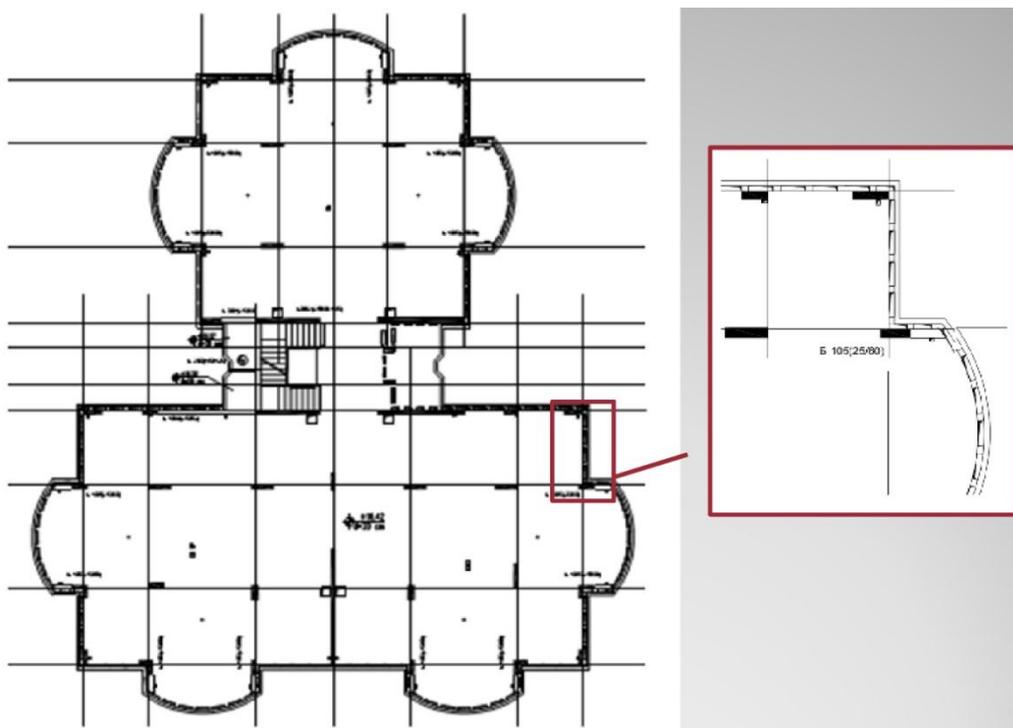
План несущих элементов каркаса с большой сеткой колонн
